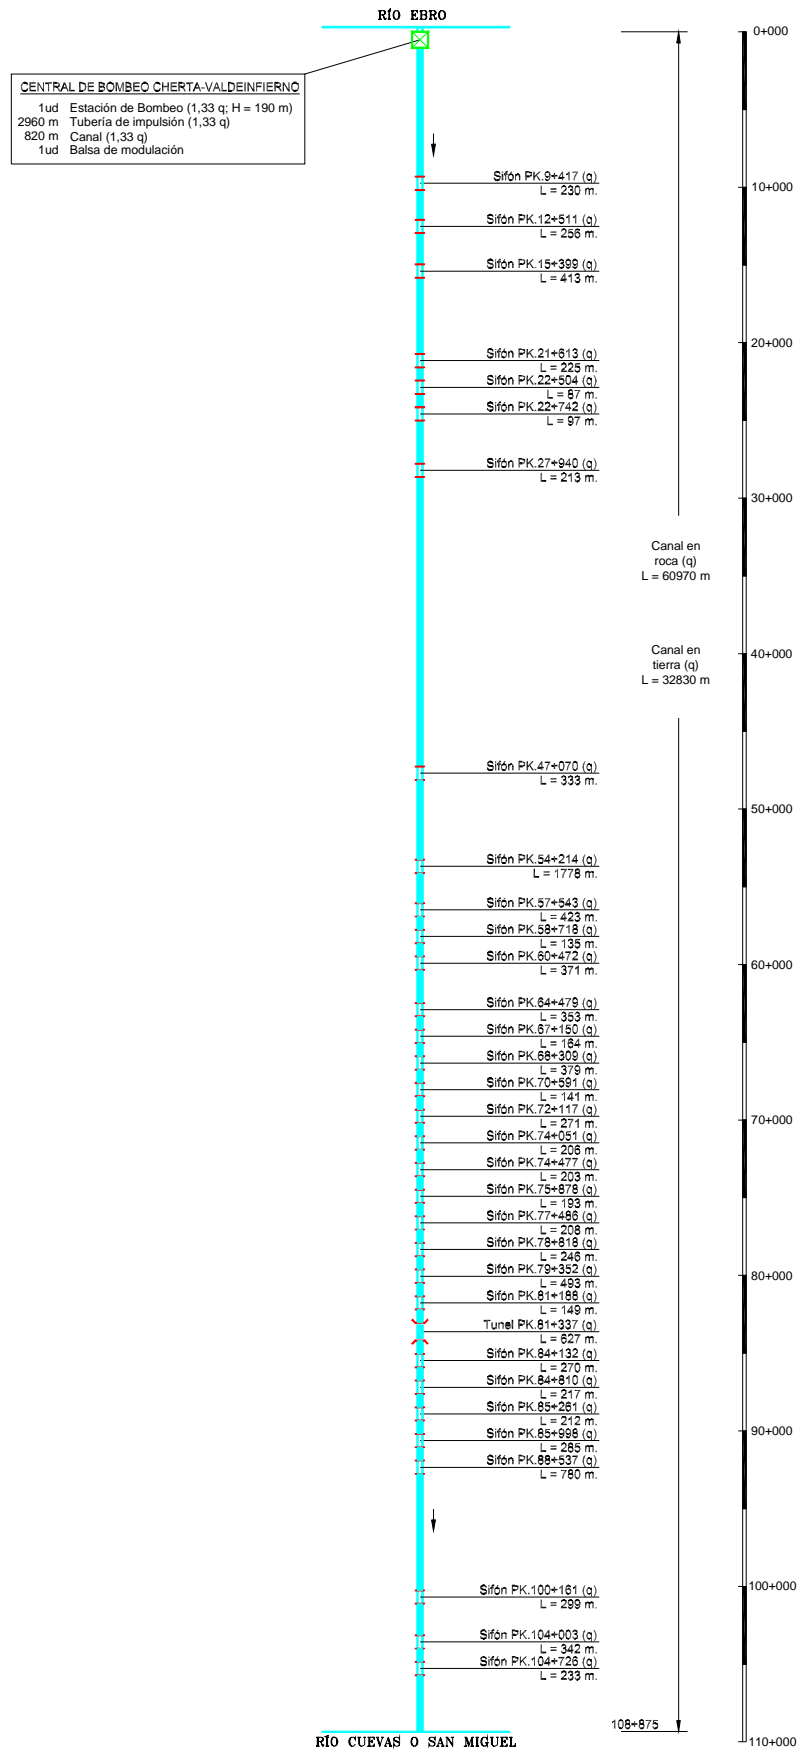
Conducción Ebro-Castellón Norte. Esquema en planta
